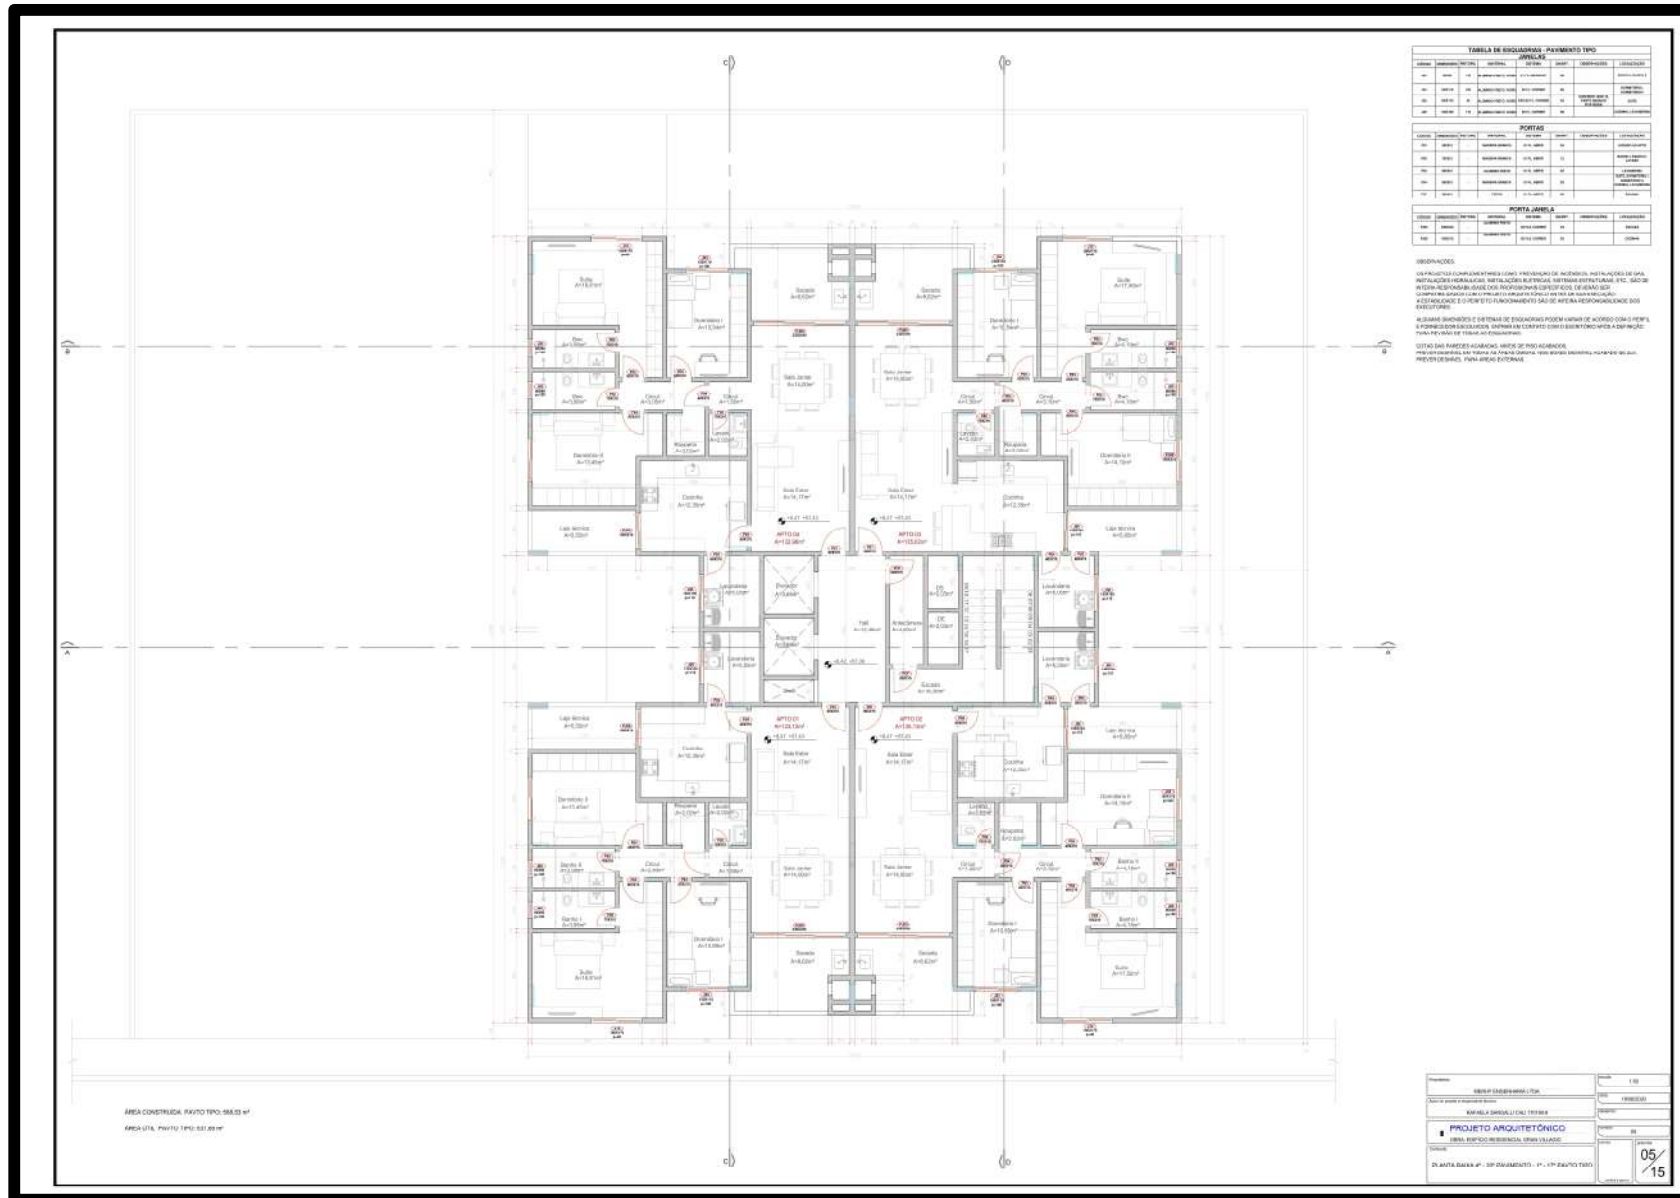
Planta pavimento topo. Fonte: Construtora Merhy (2020).
